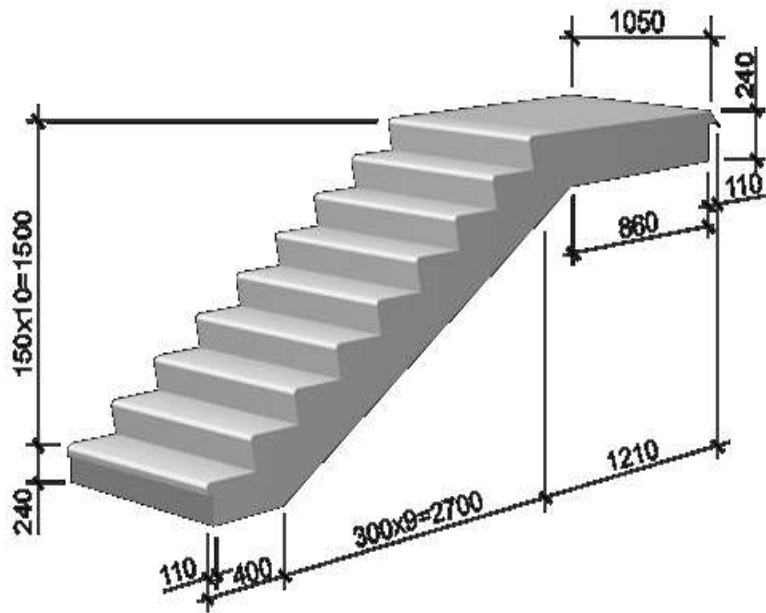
Лестничные марши железобетонные совмещенные с лестничными площадками
